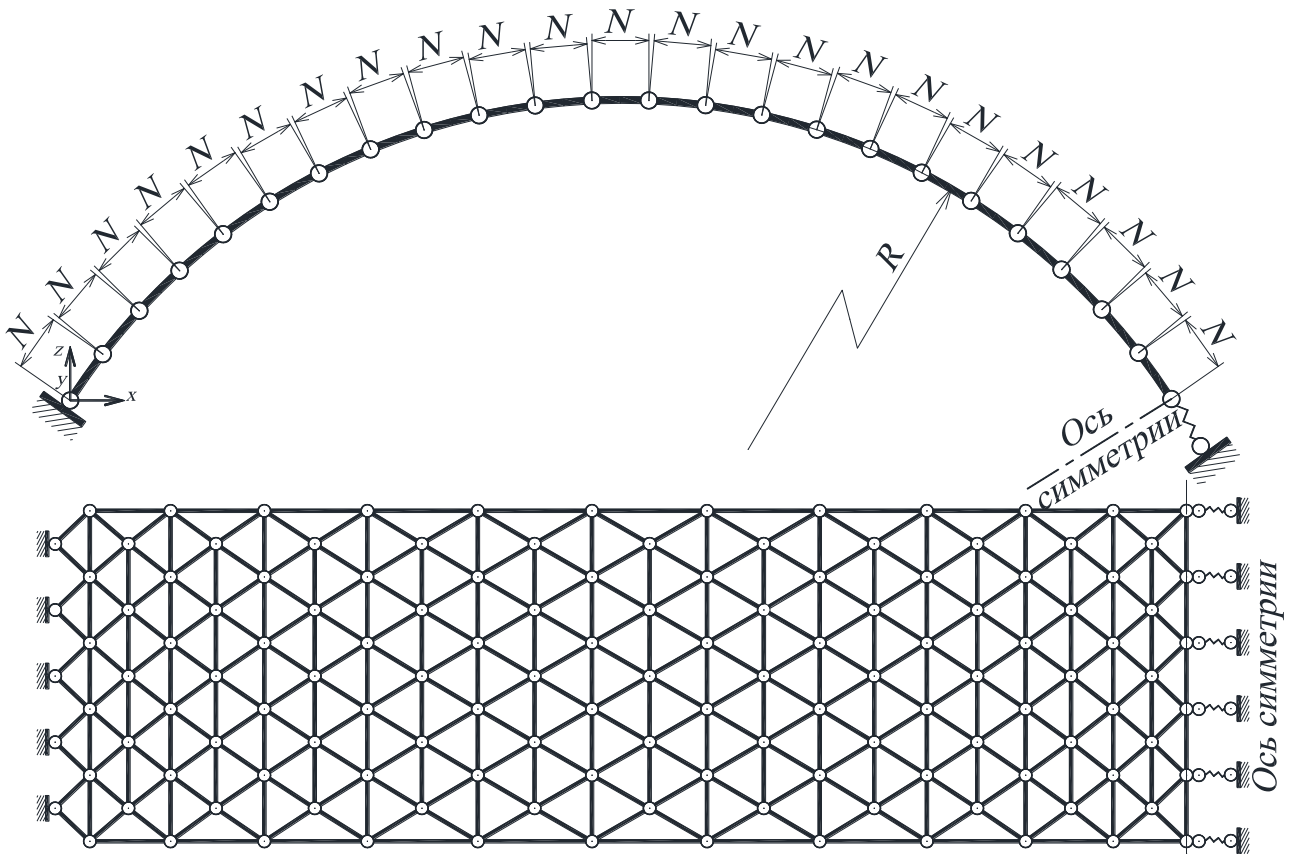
Схема однослойной цилиндрической оболочки покрытия.
